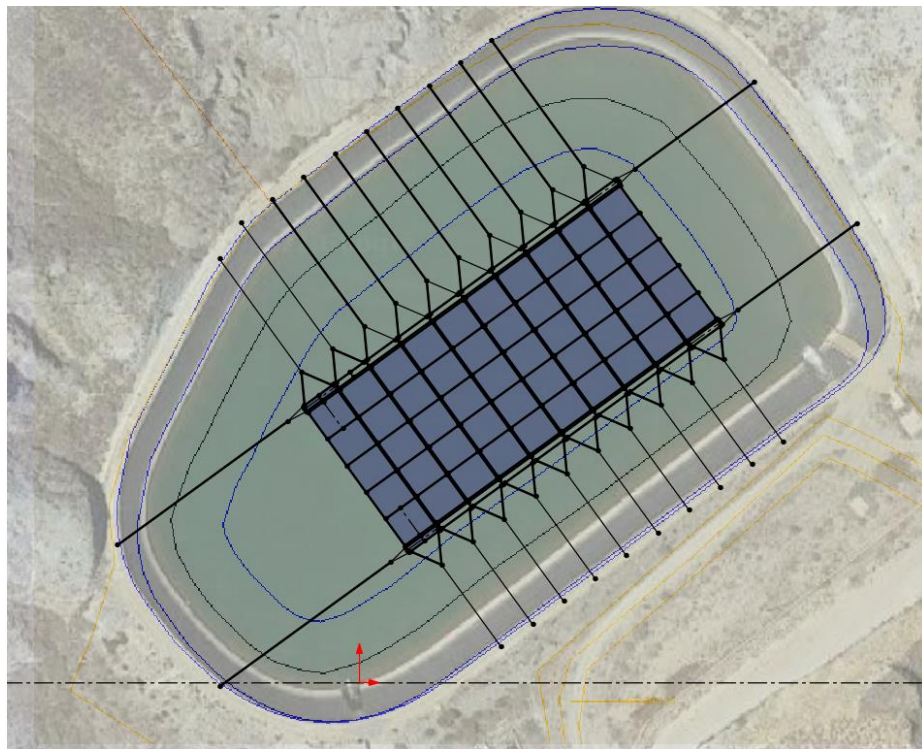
Vista en planta de la instalación fotovoltaica sobre la Balsa Abellán
